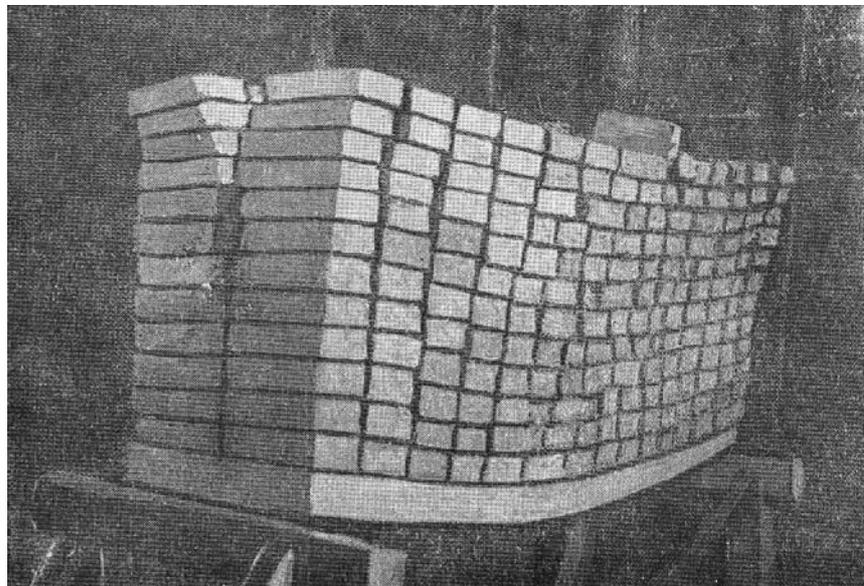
Испытание гипсовой плиты перекрытия (1961 г., нагрузка соответствует весу 336 кирпичей)
